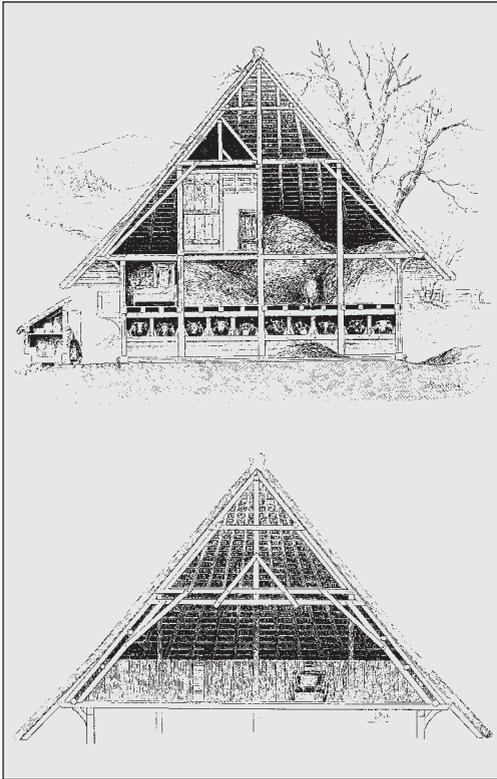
Querschnitt eines Hofgebäudes mit Firstständern und „stehendem Dachstuhl“ über dem Stall (oben) und „liegendem Dachstuhl“ mit abgefangenen Restfirstständern über dem Wohnteil (unten). Die „liegenden Dachstühle“ der Gutachtäler und Kinzigtäler Häuser sind in aller Regel so konstruiert, dass auf Restfirstständer verzichtet werden konnte (siehe Abb. 8).
